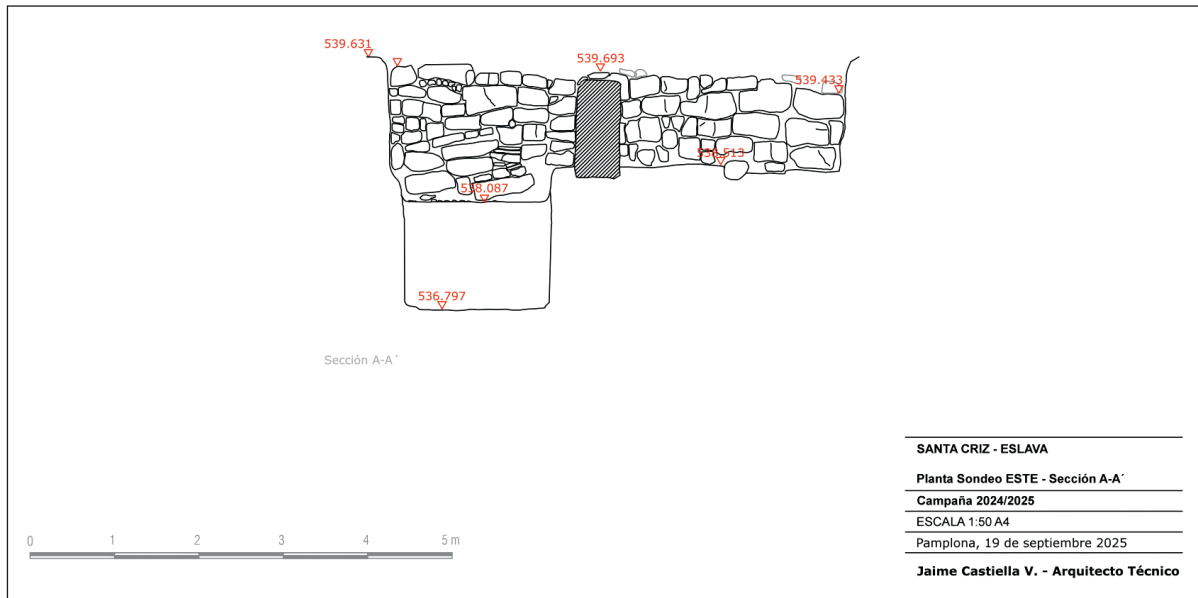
Alzado del sector este, en el que se representa la muralla (UE 25207) con su correspondiente zócalo (UE 25211), y el posterior muro de compartimentación (UE 25202). Plano: © J. Castiella.
